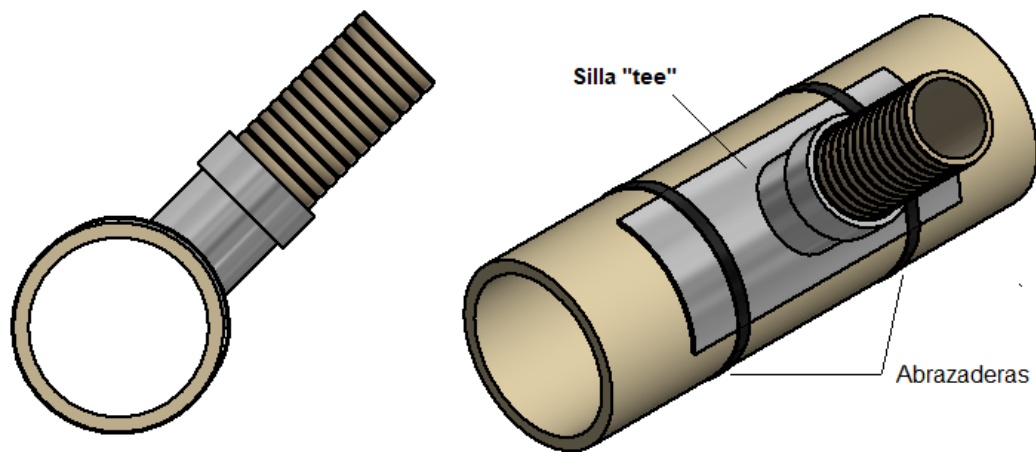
Conexión a tubería PVC con accesorio silla "tee"
